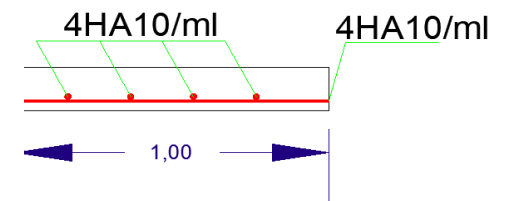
Ferrailage en travée de la dalle pleine d'ascenseur
